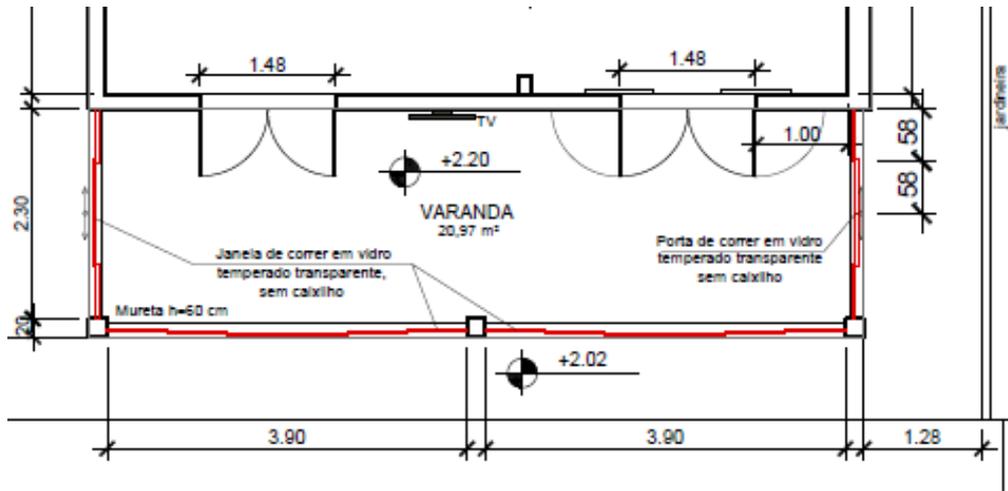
PLANTA BAIXA VARANDA E FECHAMENTO A SER INSTALADO
